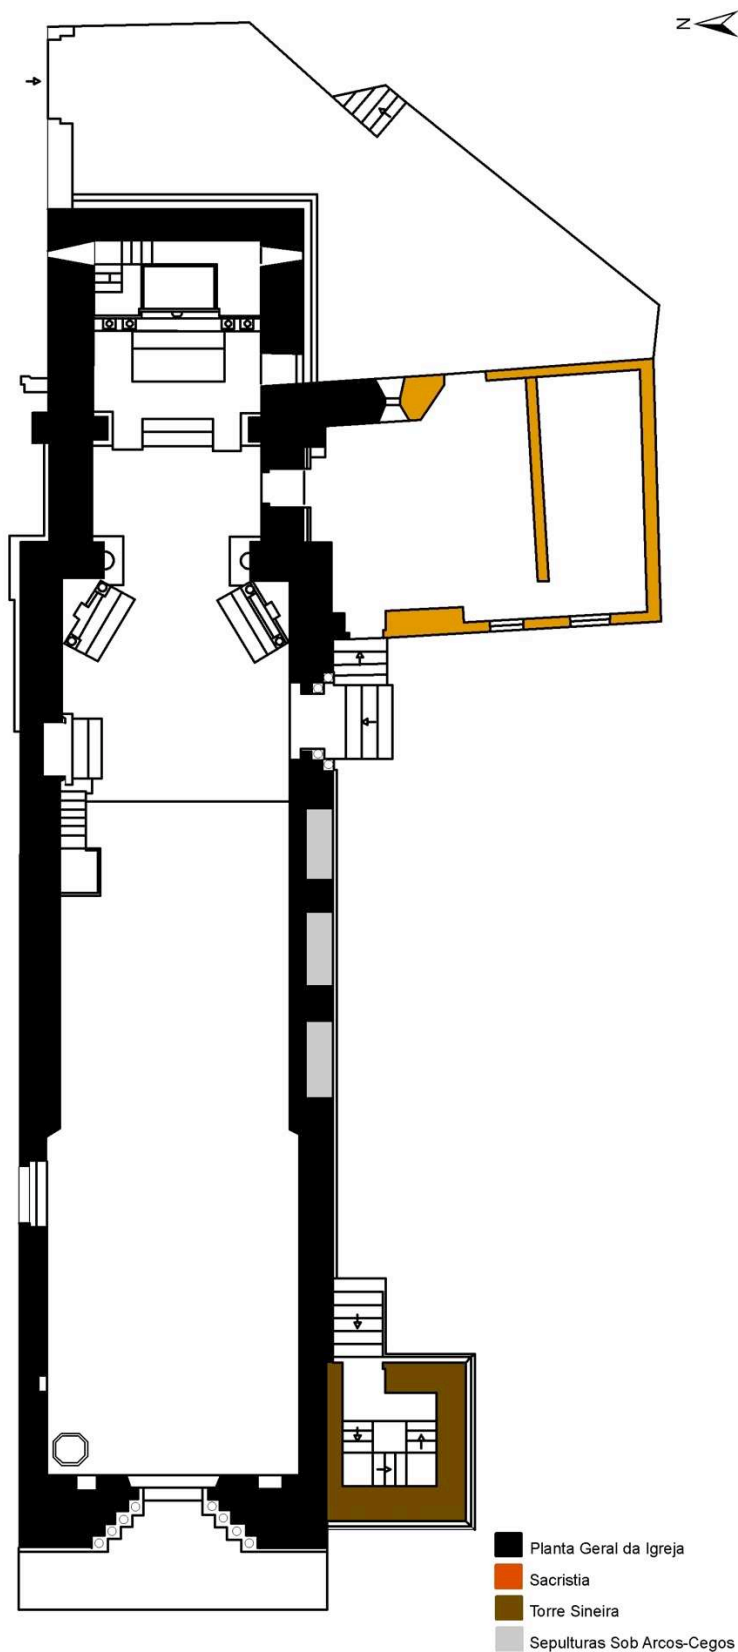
Planta da igreja de Vila Boa de Quires (DGEMN)
